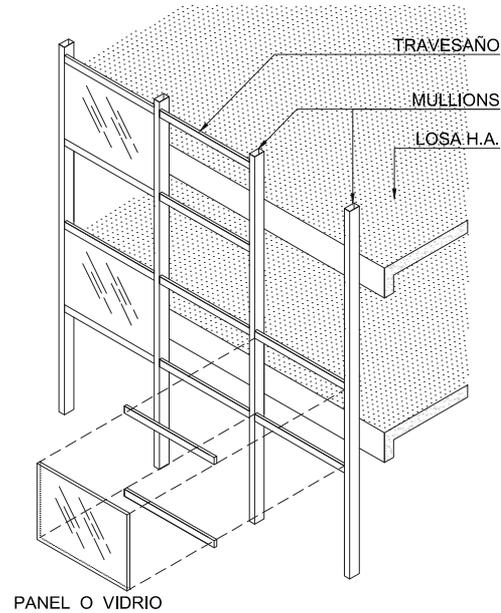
Sistema de Muro Cortina Tipo Stick.
